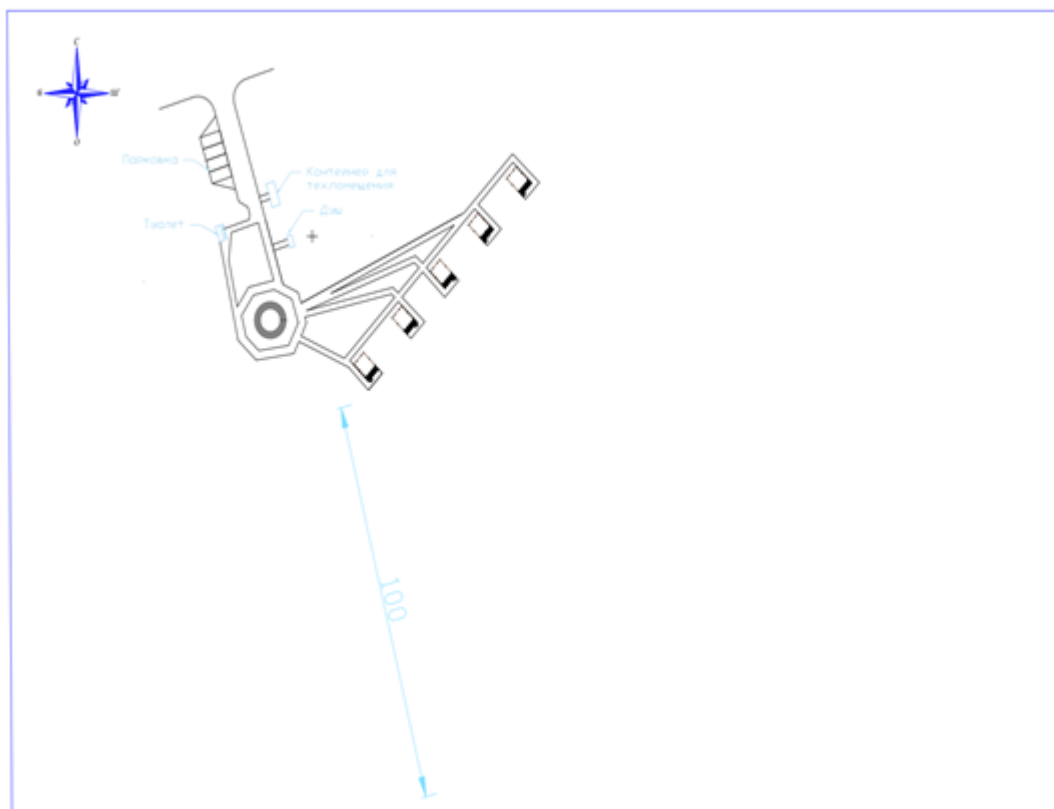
Генплан глэмпинга возле Капшагайского водохранилища
